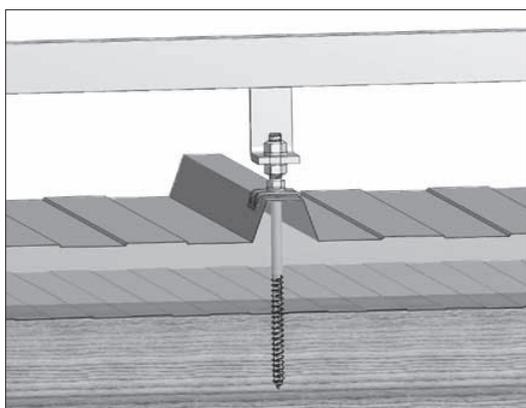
Dispositivo de fijación solar en una subestructura de madera
